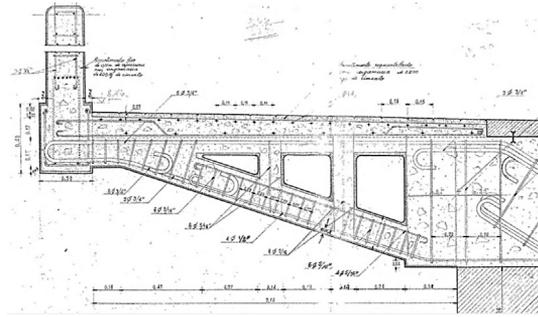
Corte longitudinal da viga (retirado do projeto original) [9].
